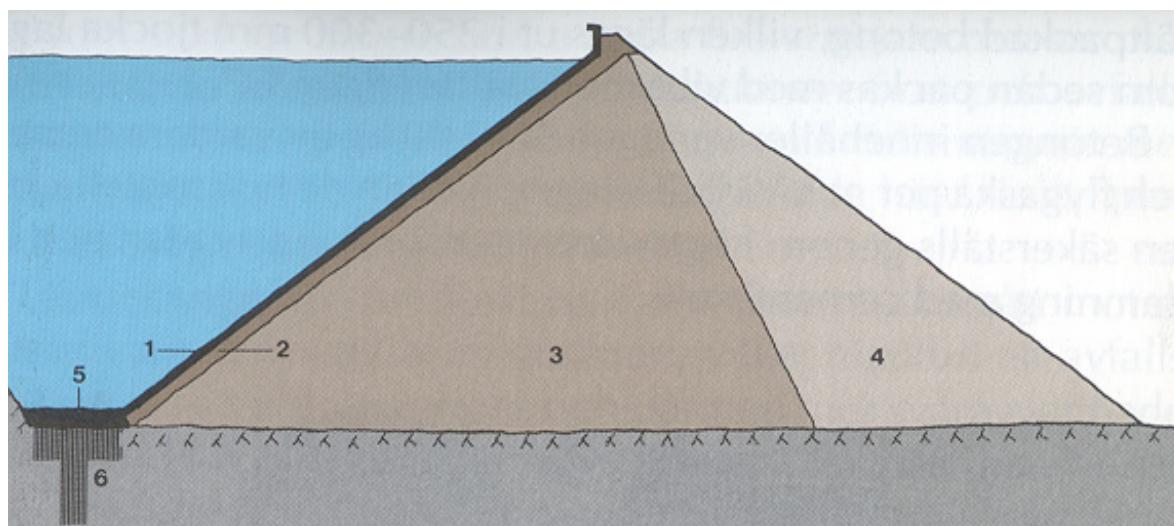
Schematisk bild av låg damm (< 15m) grundlagd på otät undergrund av jord. Vattenfall (1988).
